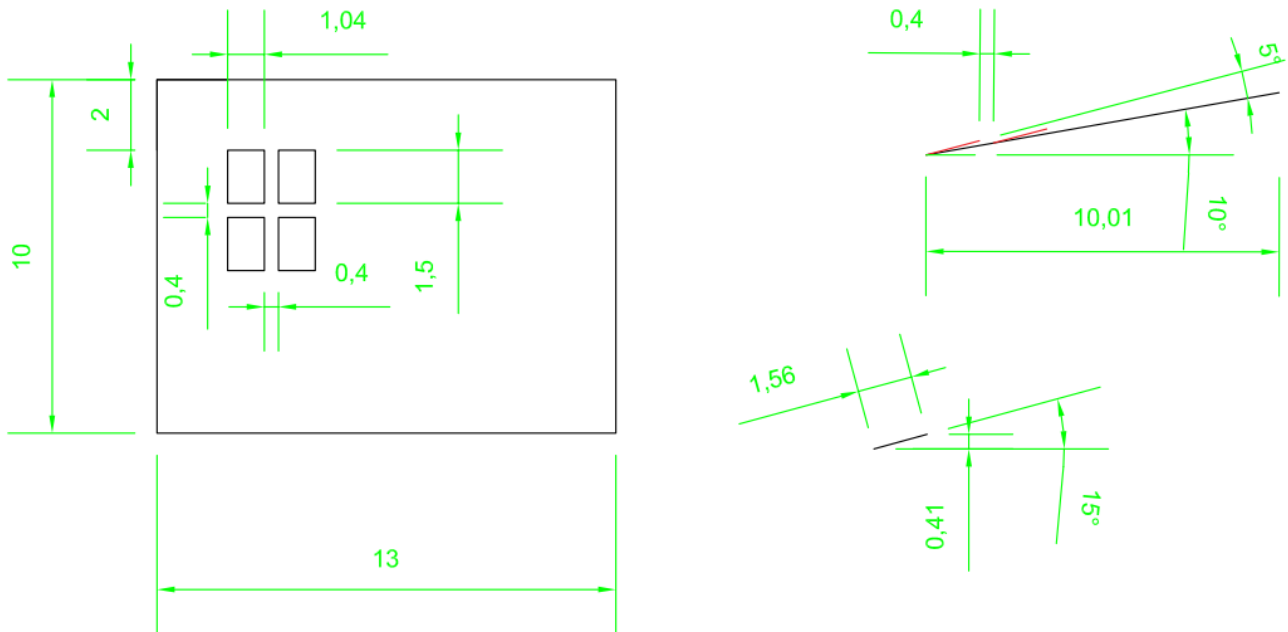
Vistas de alzado y planta de instalación en el tejado. Fuente: Autocad
